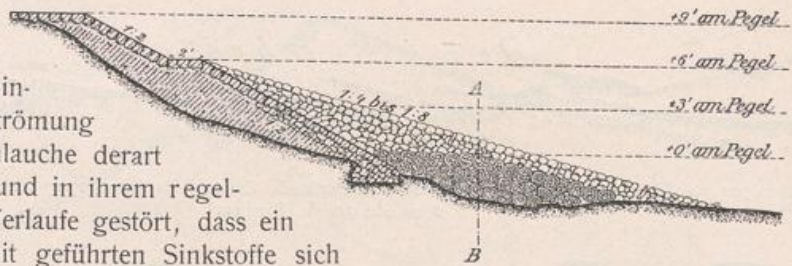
Querschnitt durch das mit Deckwerk und Kopfschwellen ausgebaute Lüttinger Ufer.
